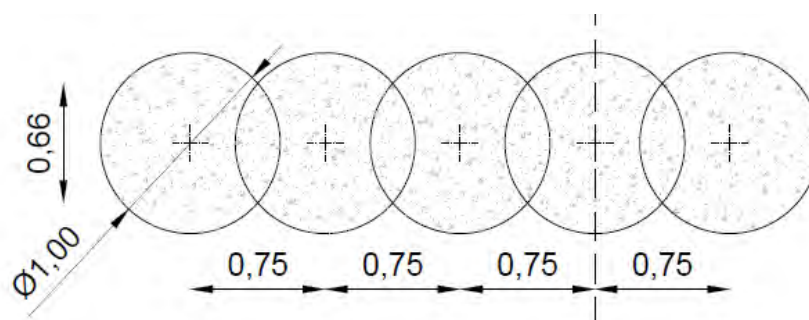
Schema di diaframma continuo con colonne jet grouting secanti
